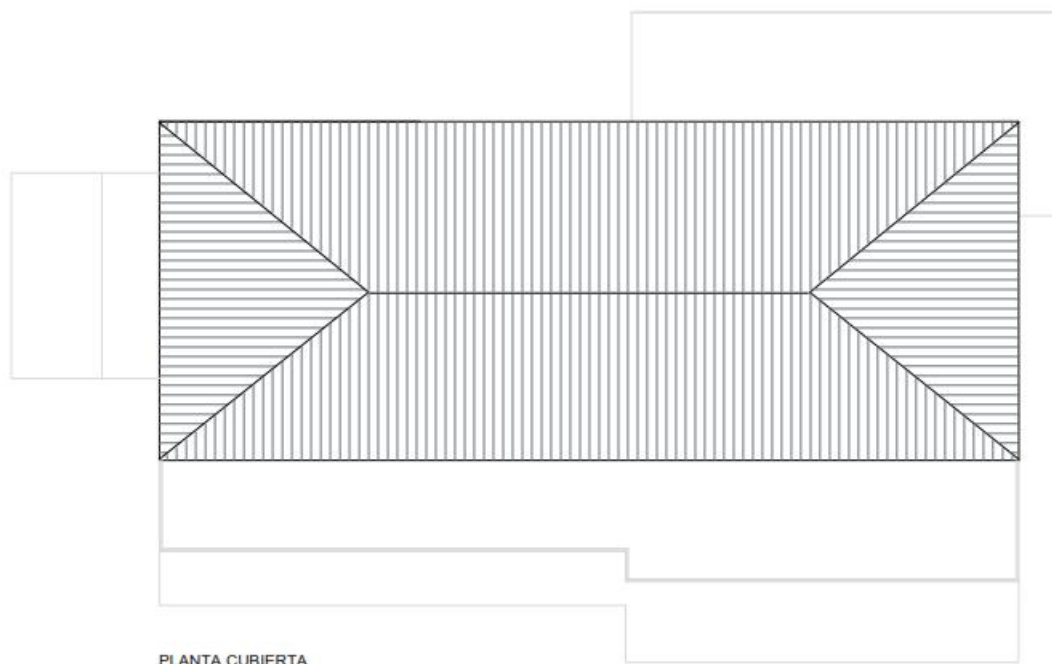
Plano de distribución de la planta de cubierta del inmueble objeto.
